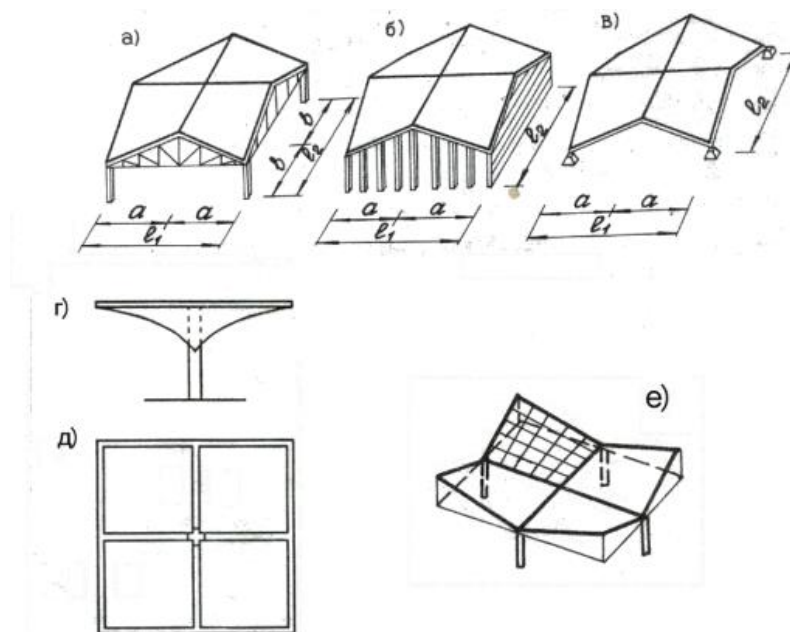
Залізобетонні гіпари на квадратному плані:
